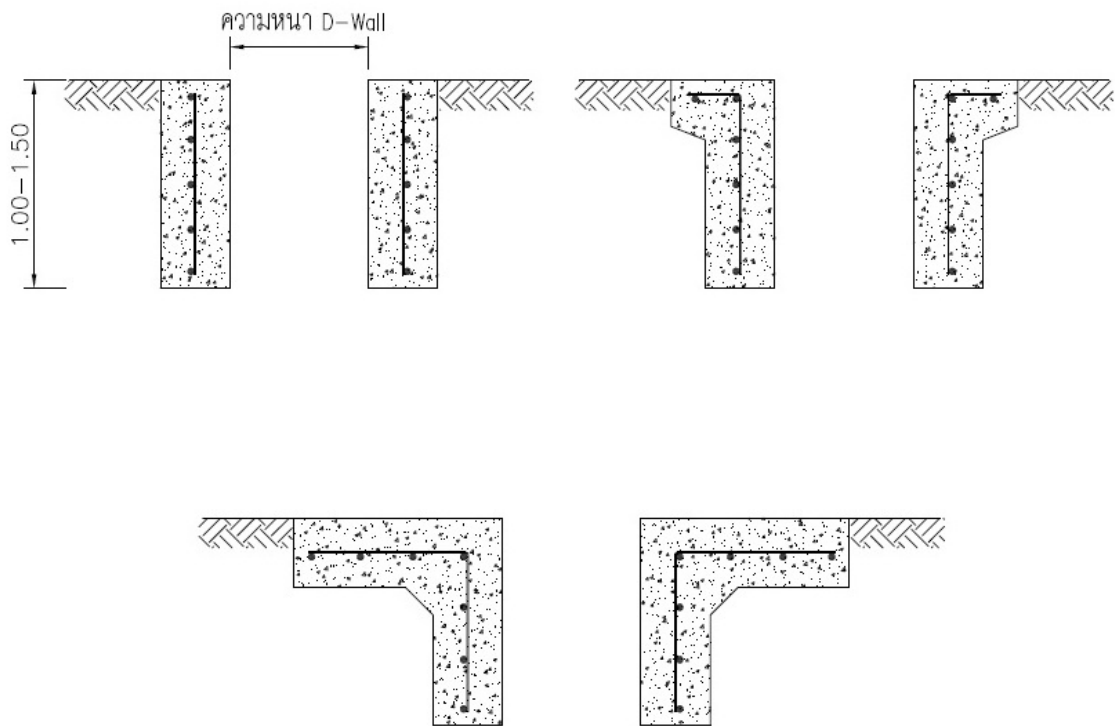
ขั้นตอนการก่อสร้าง Diaphragm Walls
